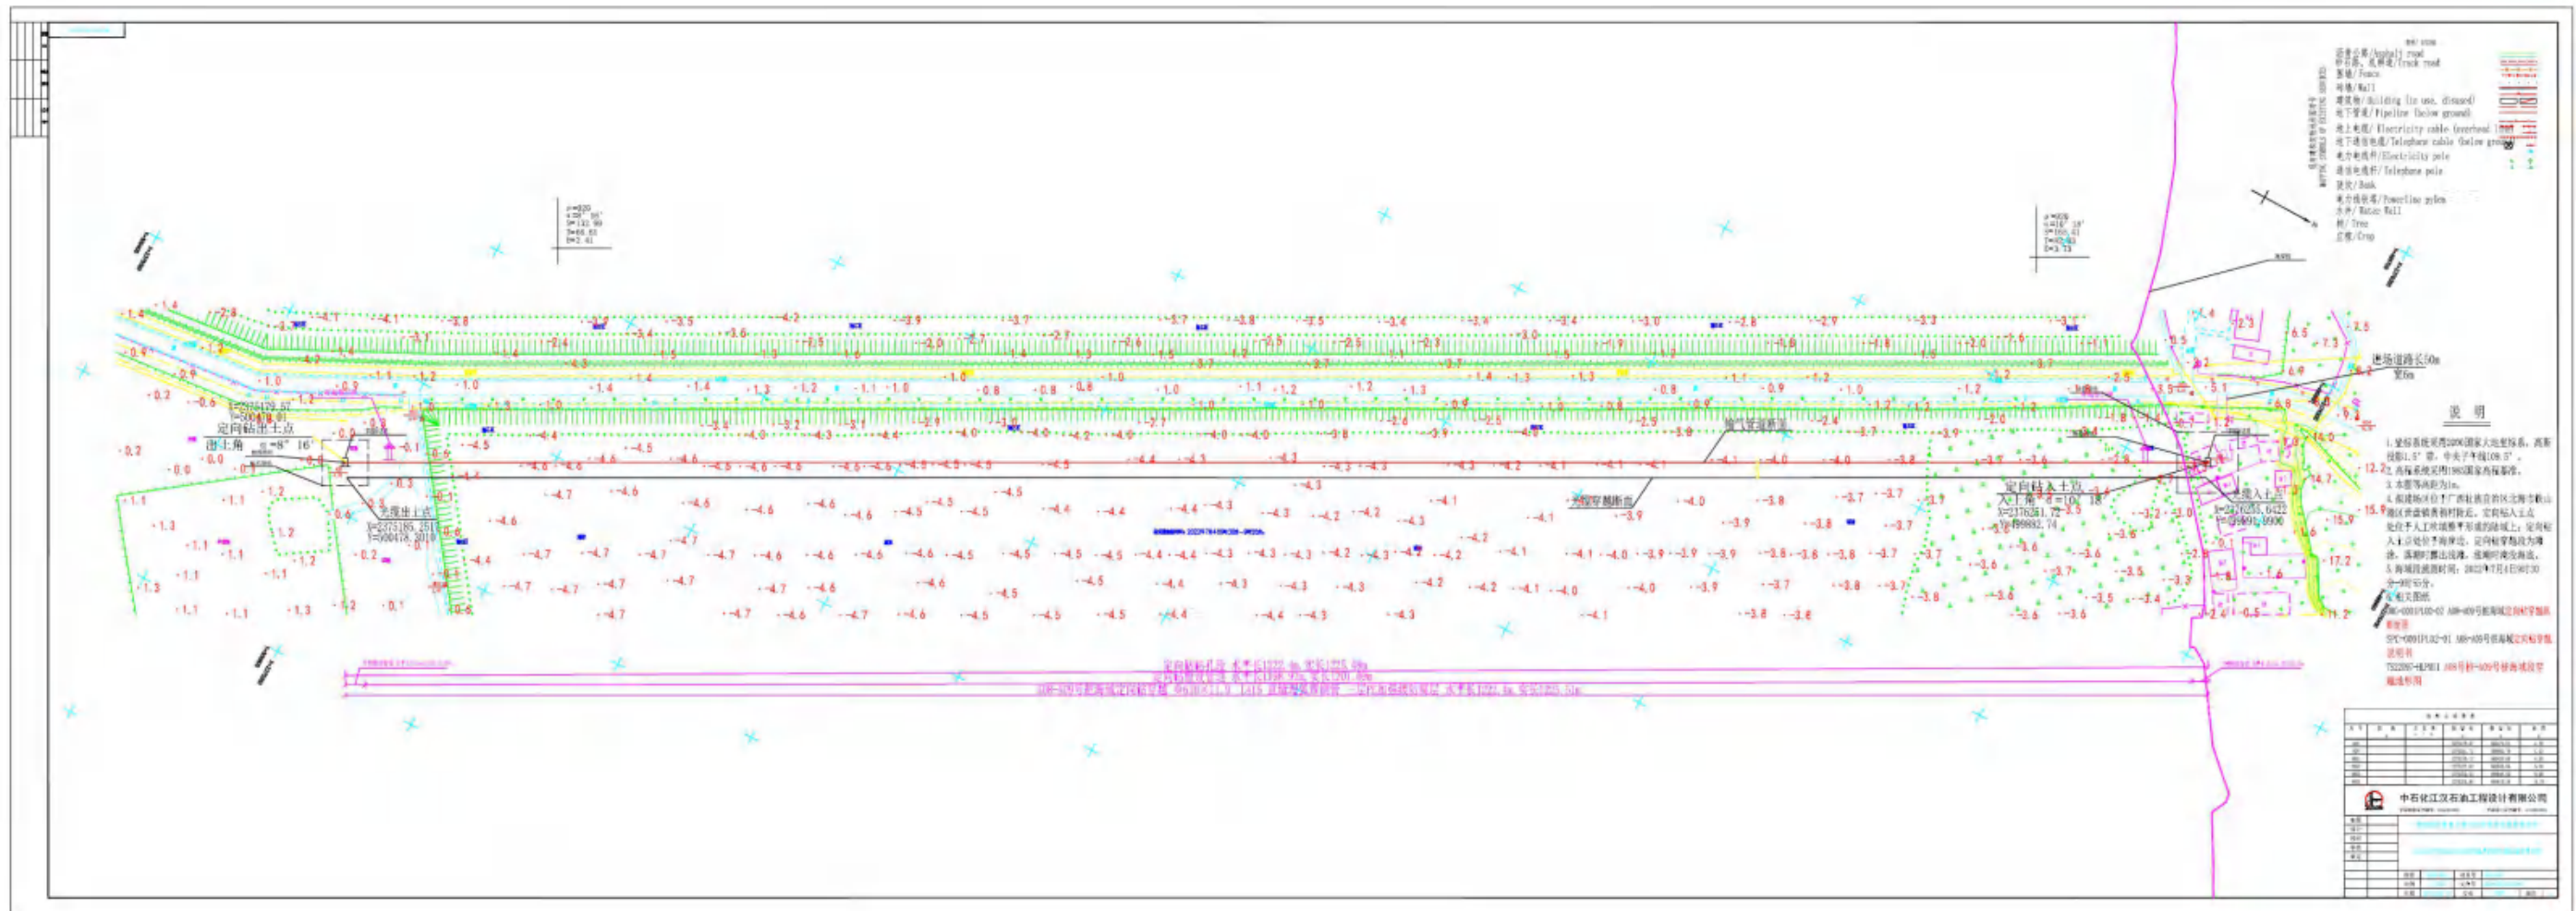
项目涉海段 1 管线定向钻穿越平面布置图
